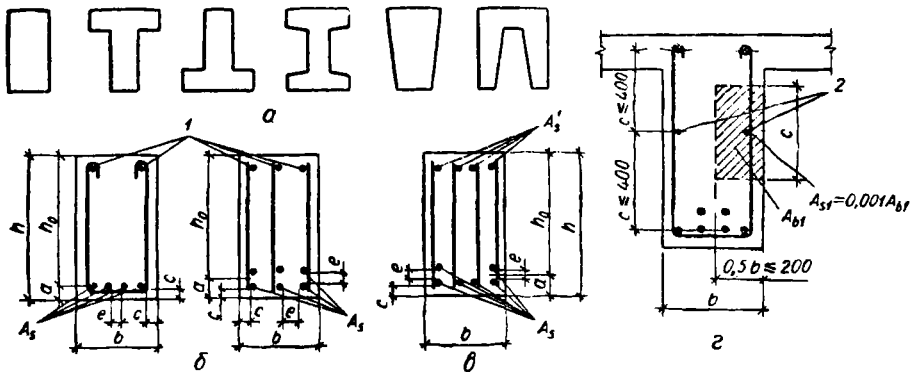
Форми поперечного перерізу залізобетонних балок та армування їх:
